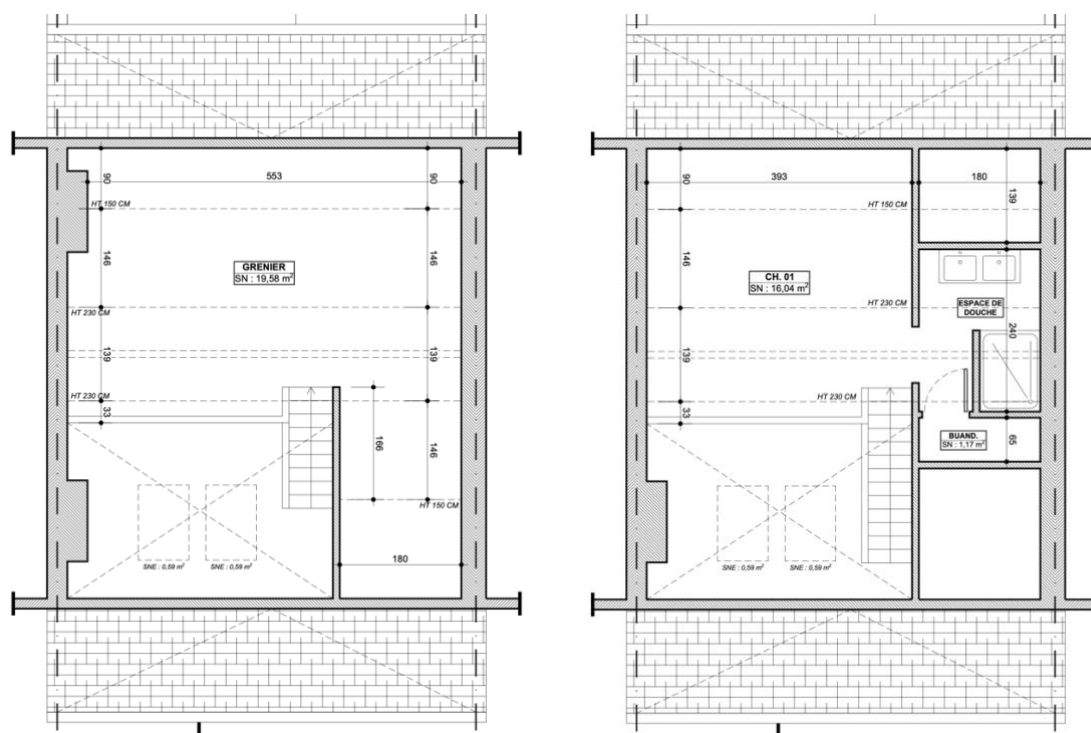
Plans des situations de droit (à gauche) et de fait (à droite) de l'aménagement de l'espace de chambre sur la mezzanine du studio du dernier étage.
